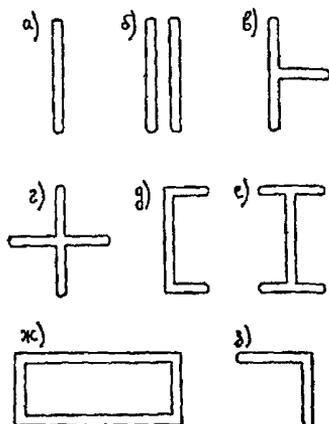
Поперечные сечения щелевых фундаментов: а - прямоугольное; б - прямоугольное с двоянным; в - крестообразное; г - тавровое; д - коробчатое; ж - коробчатое; з - угловое
